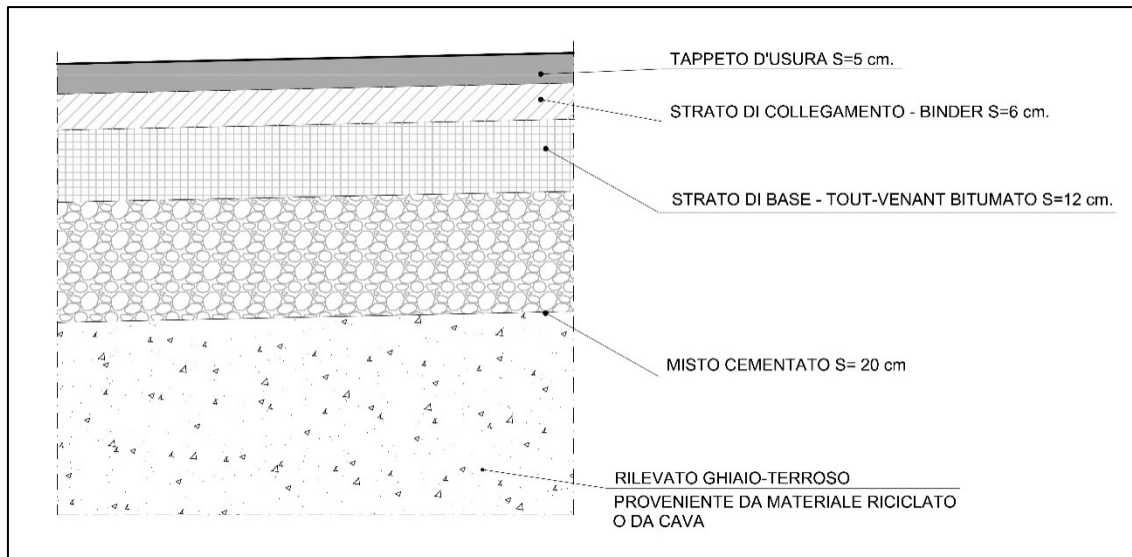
Sovrastruttura stradale strade e parcheggio P2
